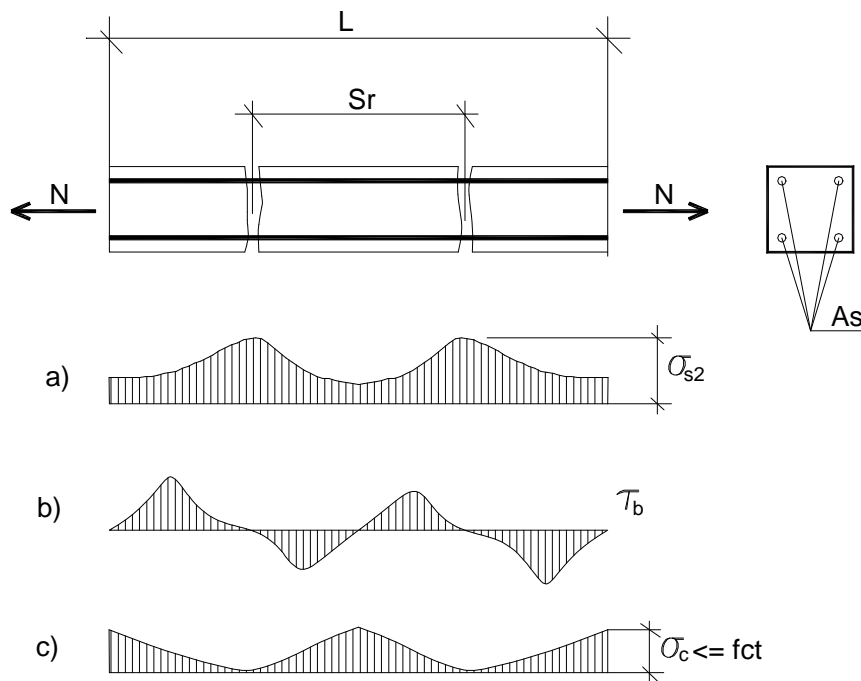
Tensões em um tirante fissurado de concreto armado: a) tensões na armadura; b) tensões de aderência; c) tensões no concreto.
